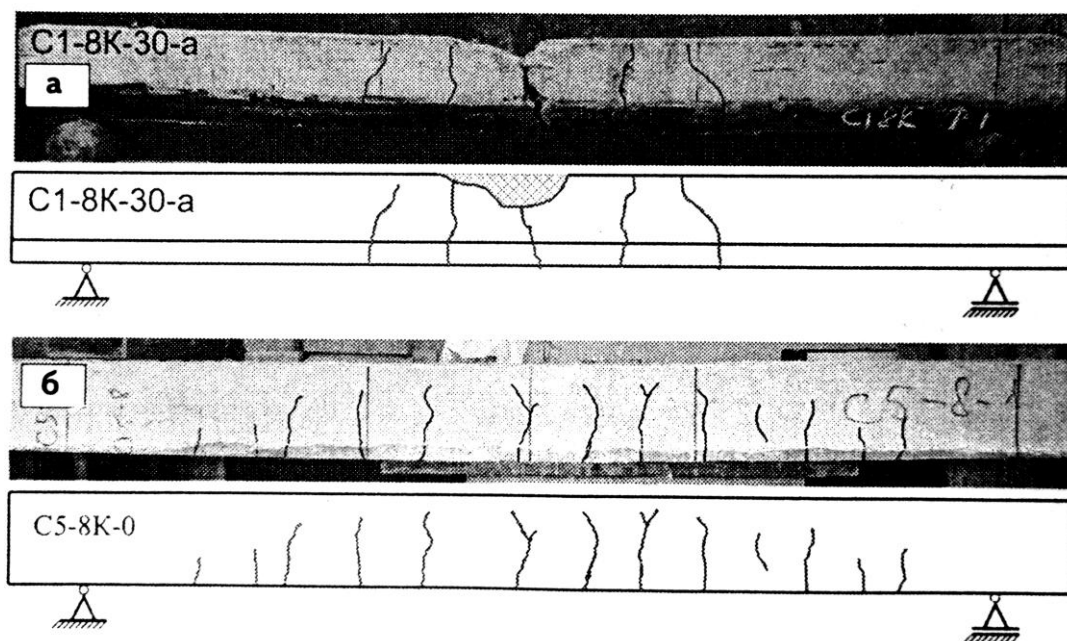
Схемы расположения трещин: а – балка двухслойная полимербетонная; б – балка железобетонная
